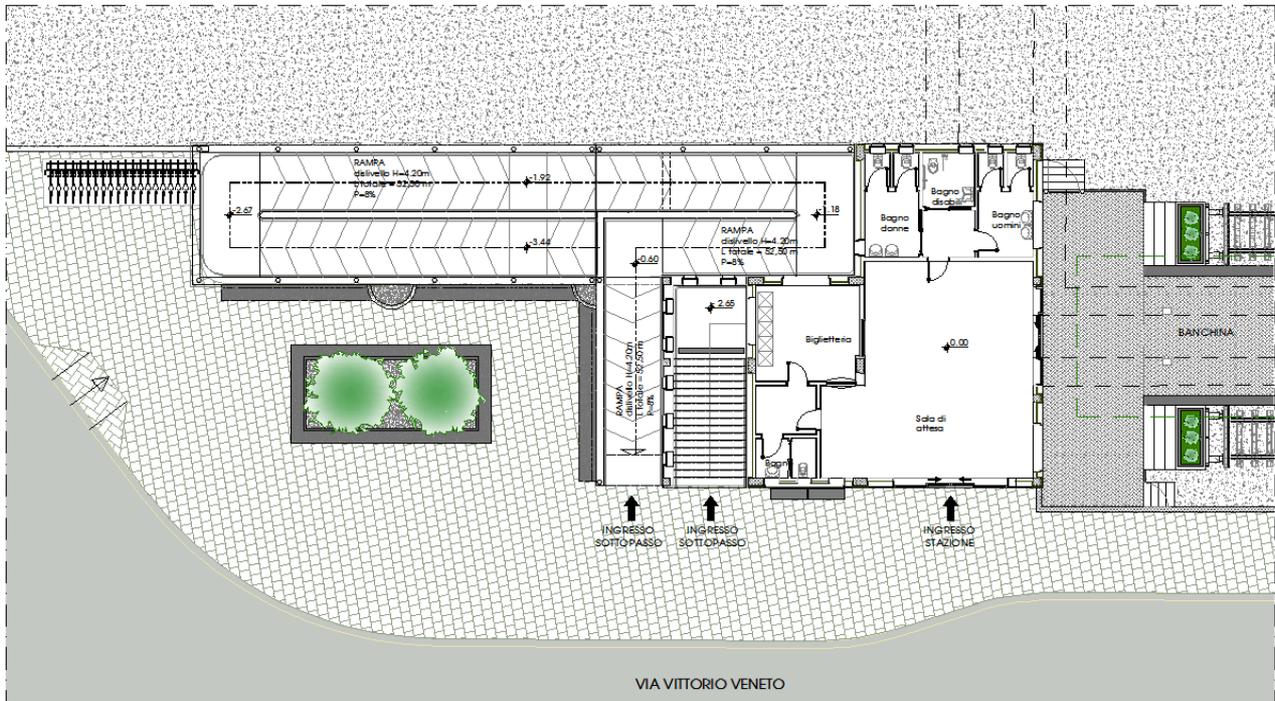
Stazione di Barletta Centrale: pianta livello accessi
